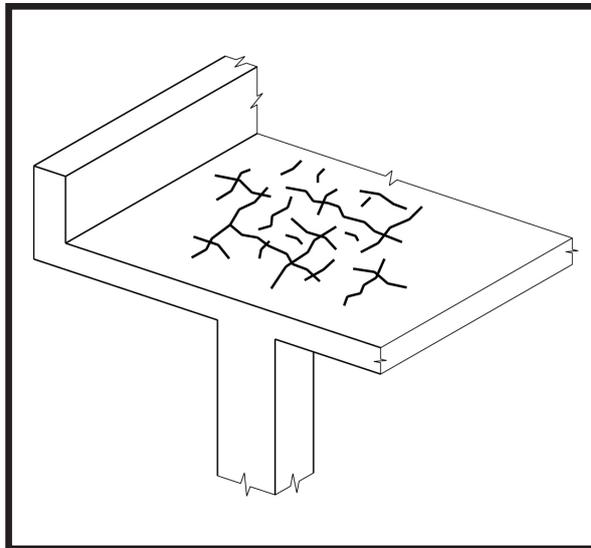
Fissuração típica de retração superficial ou dessecação superficial (CANOVAS, 1994).
